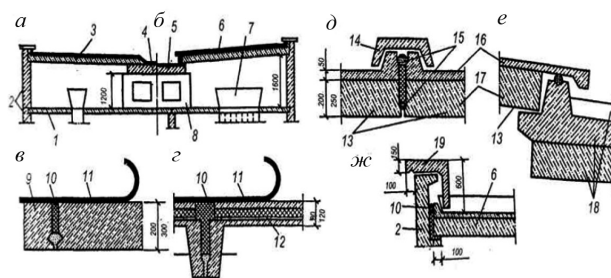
Залізобетонні дахи з теплим горищем:
